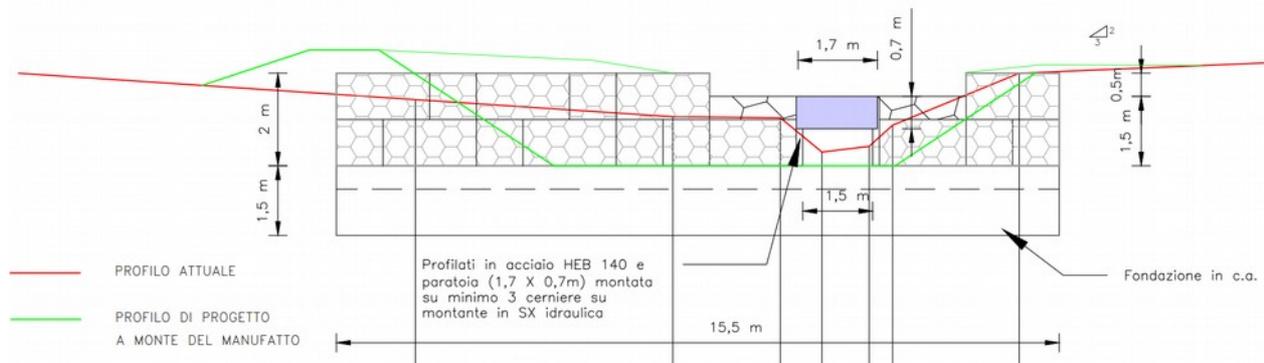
Sezione trasversale del restringimento di sezione a bocca tarata con anima in pietra.
